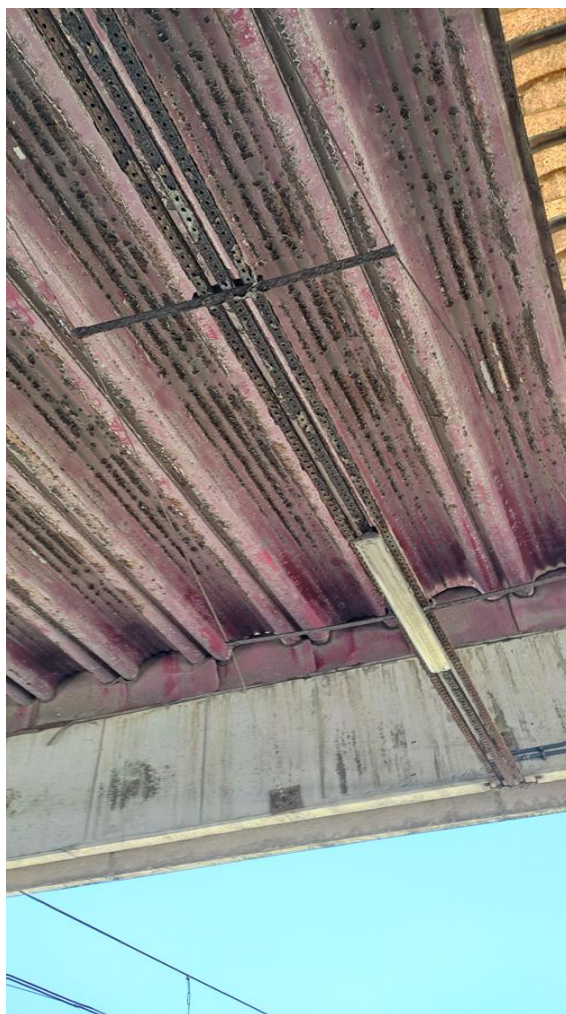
Telhas da cobertura da plataforma oxidadas
